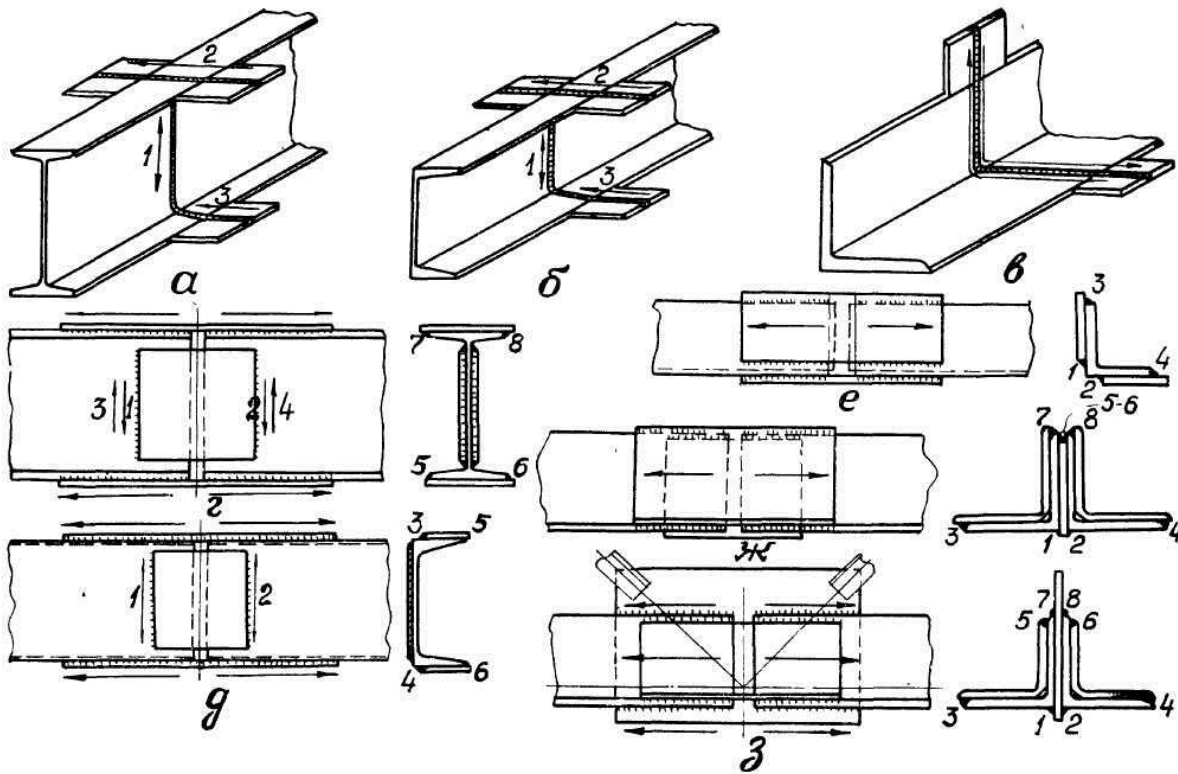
Порядок сварки монтажных стыков балок: а - прокатных, б и в - сварных; 1 - 4 - последовательность выполнения сварки
